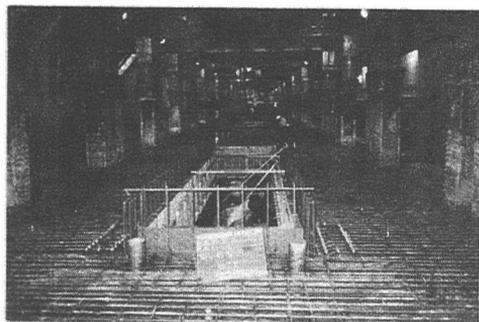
地下1階スラブ施工及び受桁・中間杭によるアンダーピニング全景
